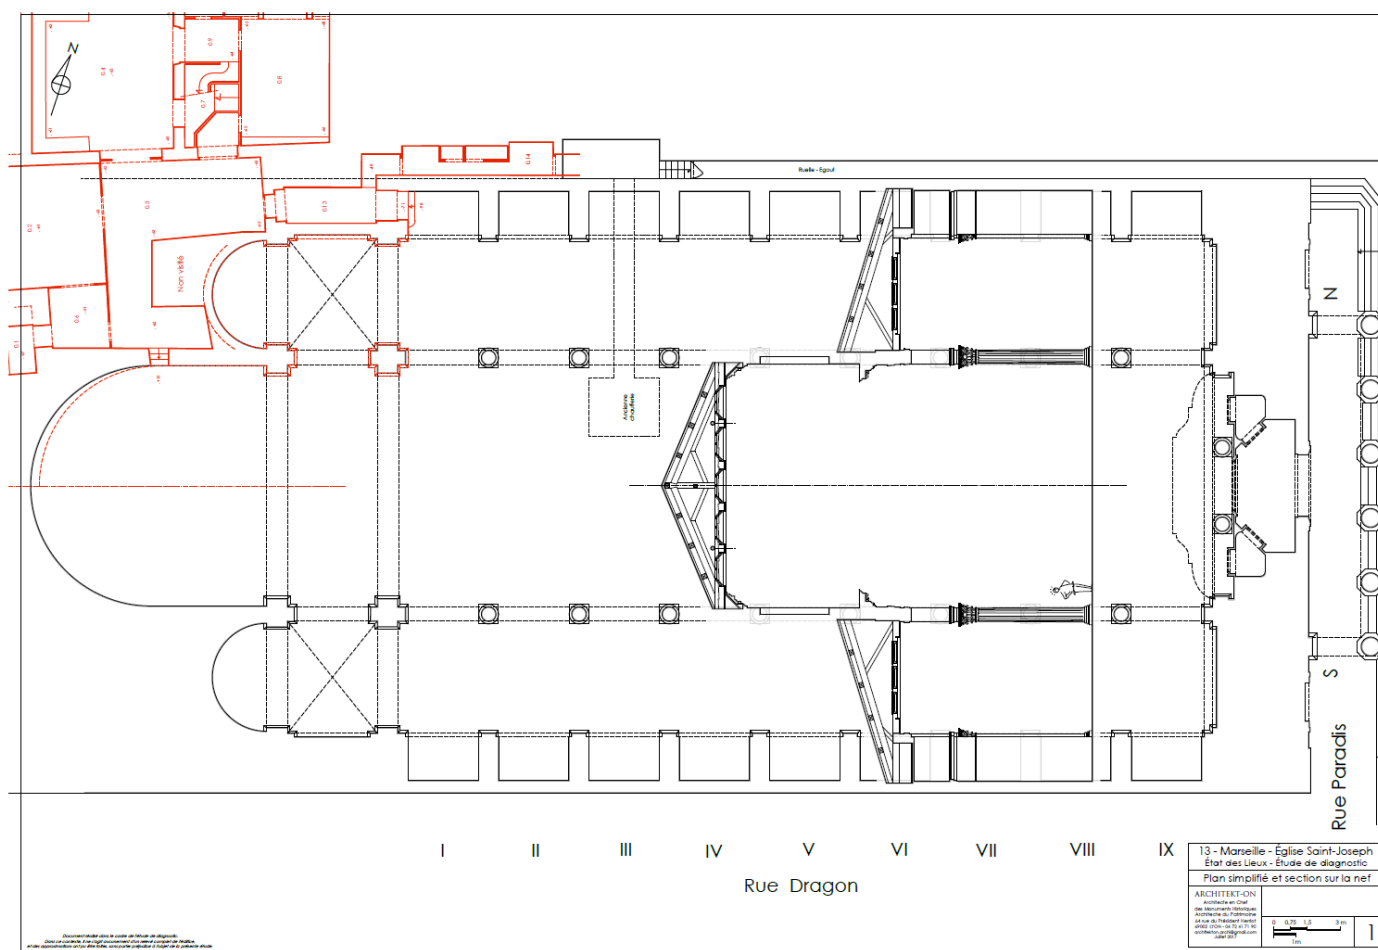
Vue en plan de l'Eglise (extrait plans Architekt-on)
